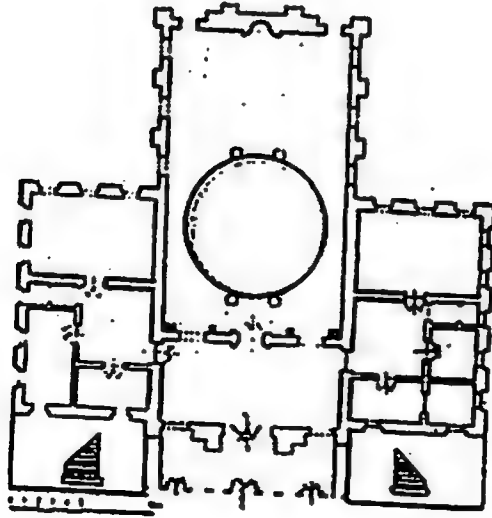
المسقط الأفقي لجامع نصرتيه .
